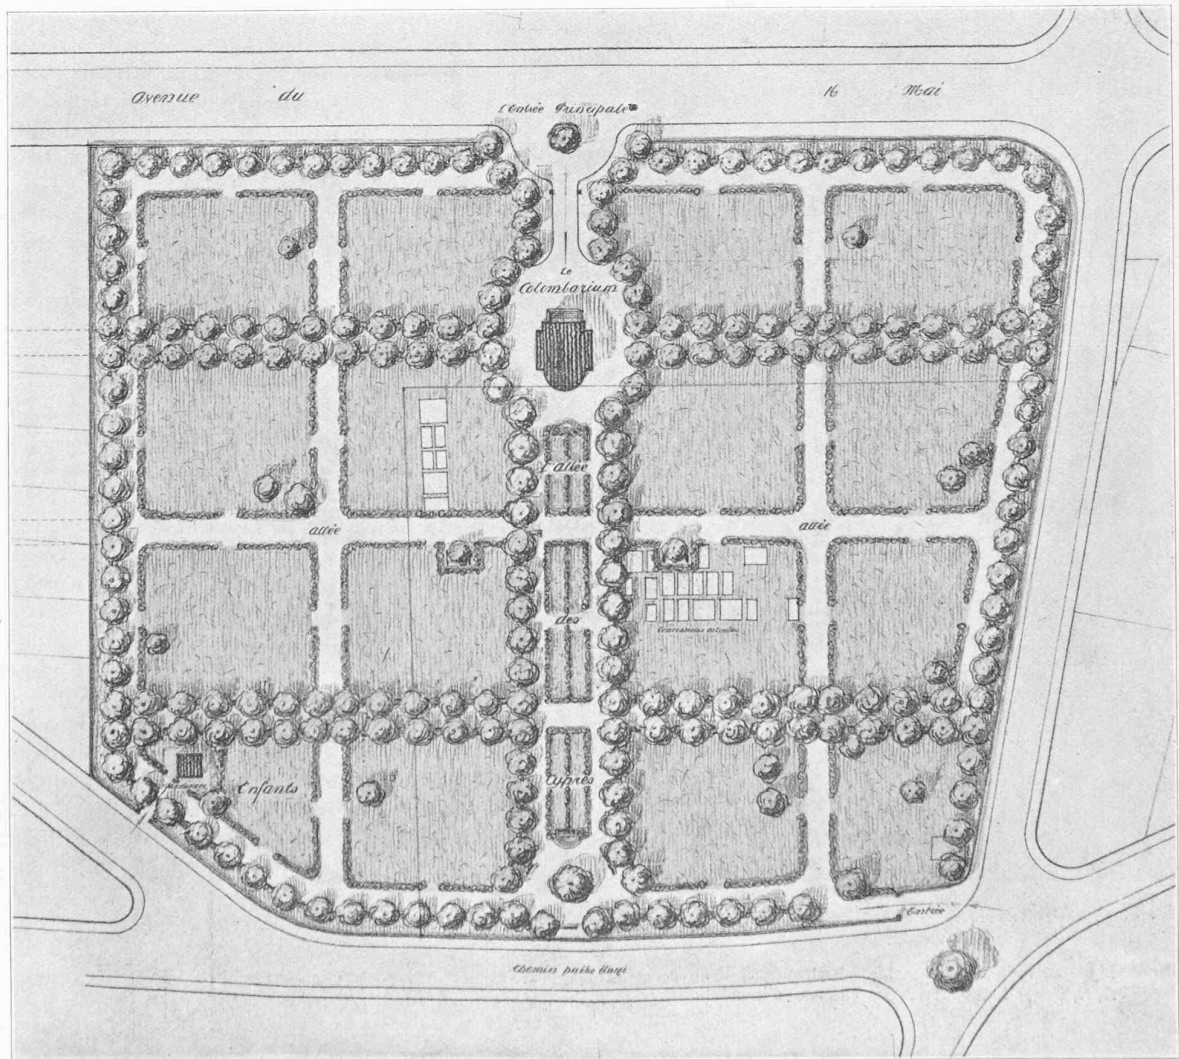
Plan du nouveau cimetière de Pully. — Echelle 1 : 1000, — M. J.-H. Verrey, archit. etc.
